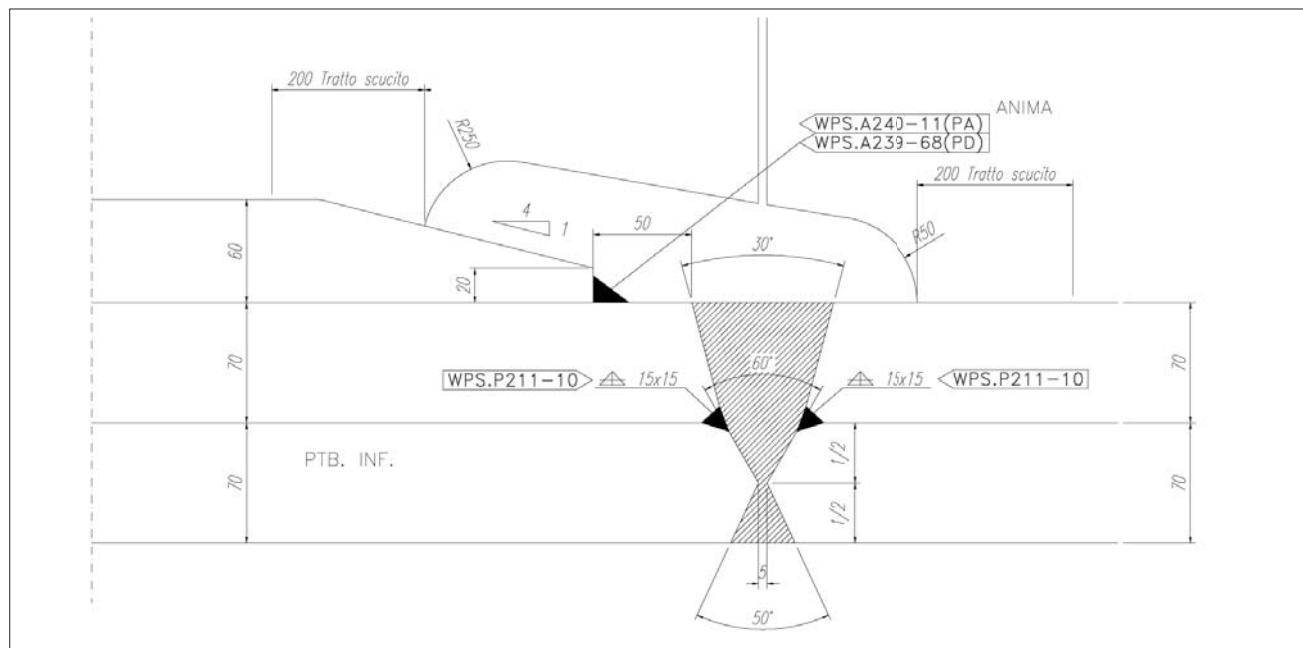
Dettaglio tipico di saldatura delle piattabande in cantiere
